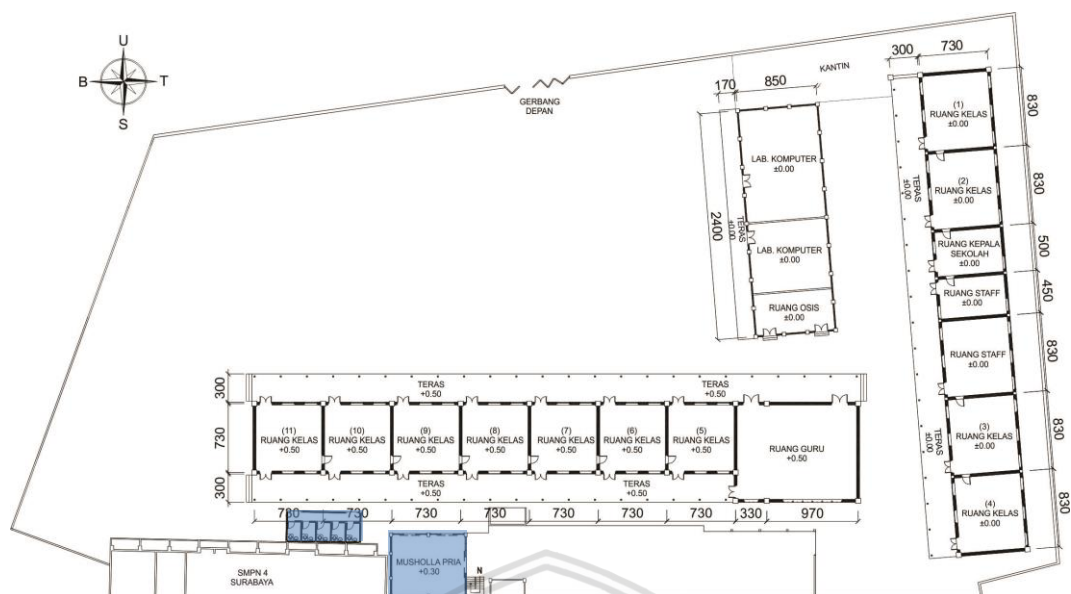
Denah Massa C SMPN 3 Surabaya
